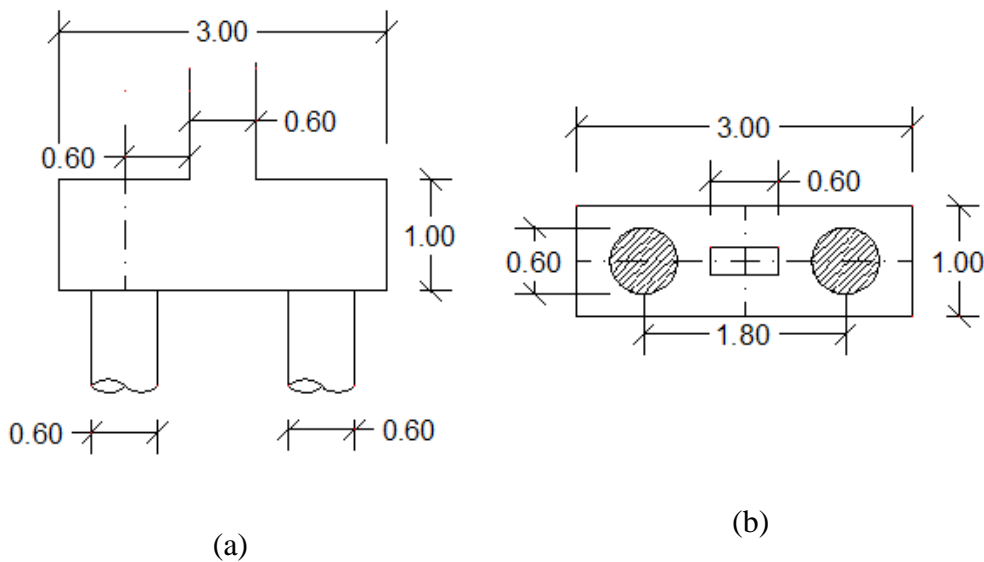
Dimensões do maciço de encabeçamento (a)-corte (b)- em planta
